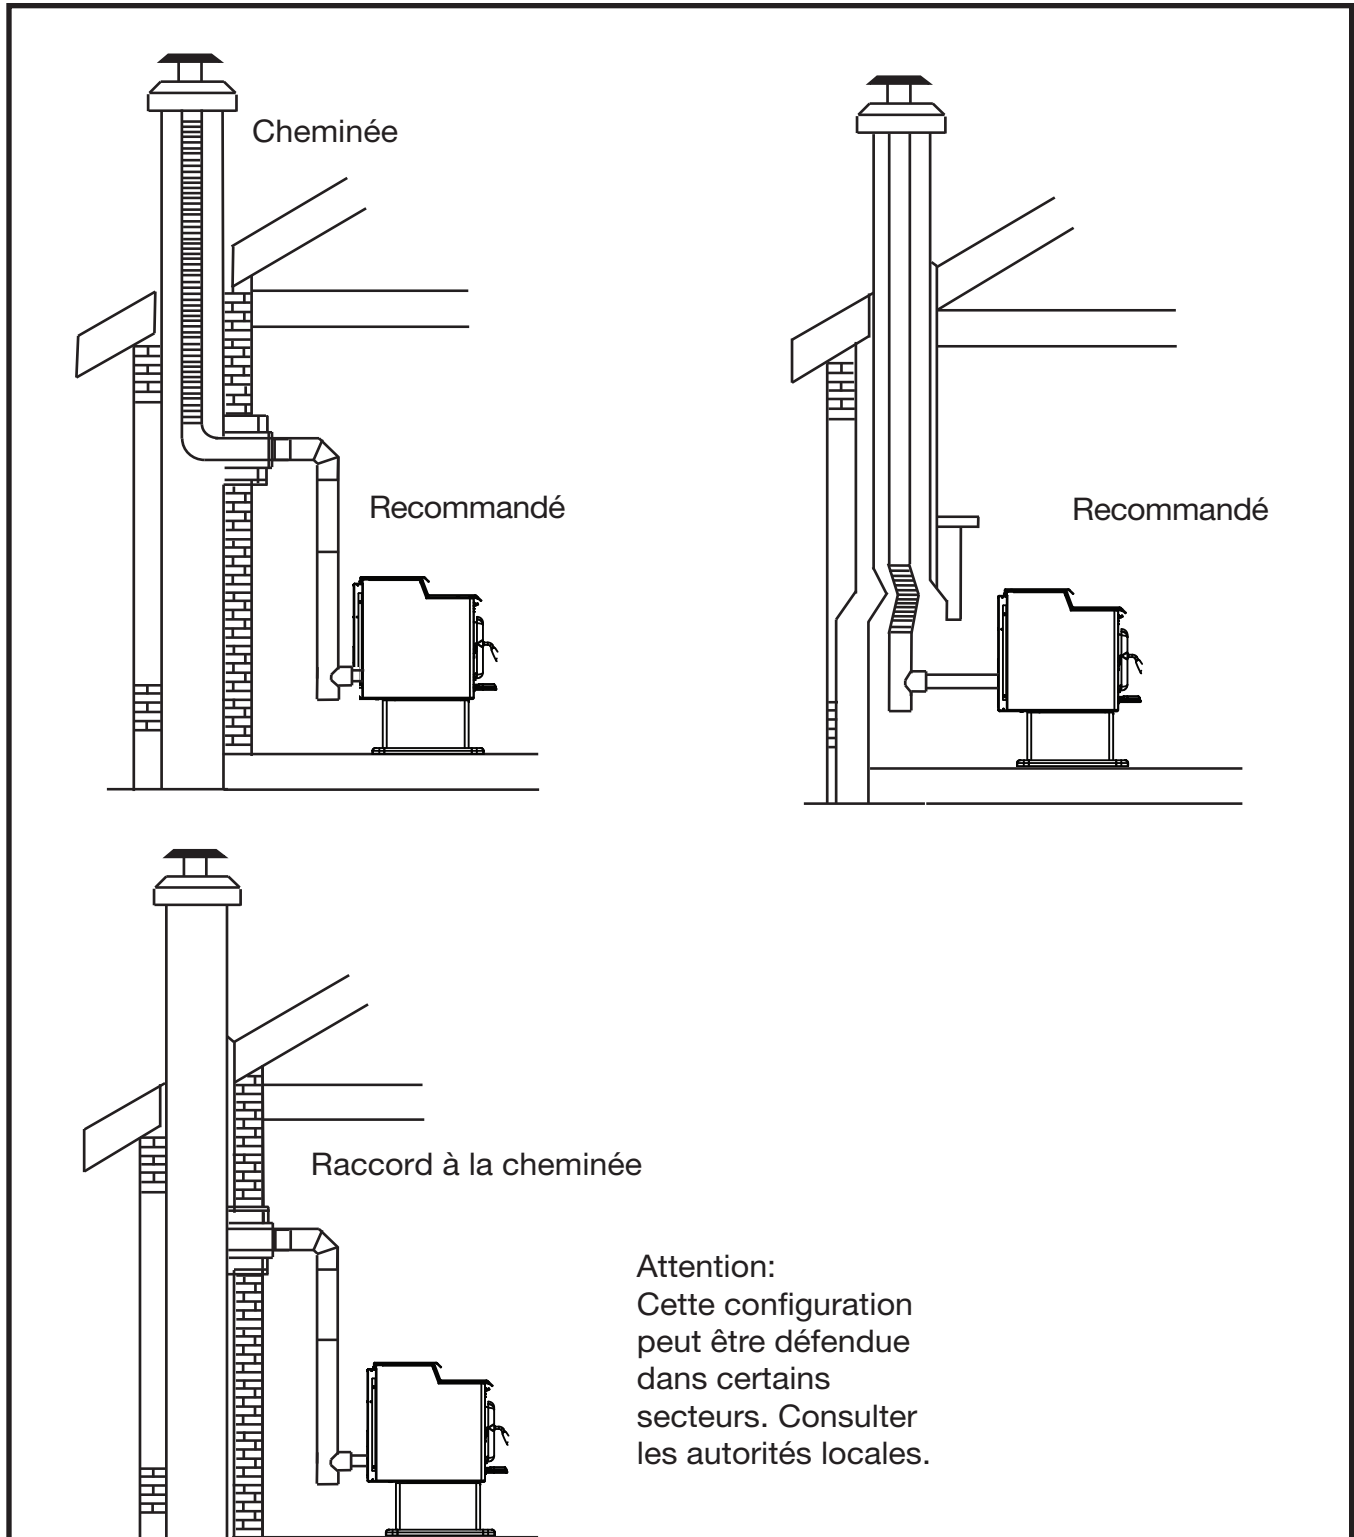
Ventilation dans une cheminée existante pour le TN40.
